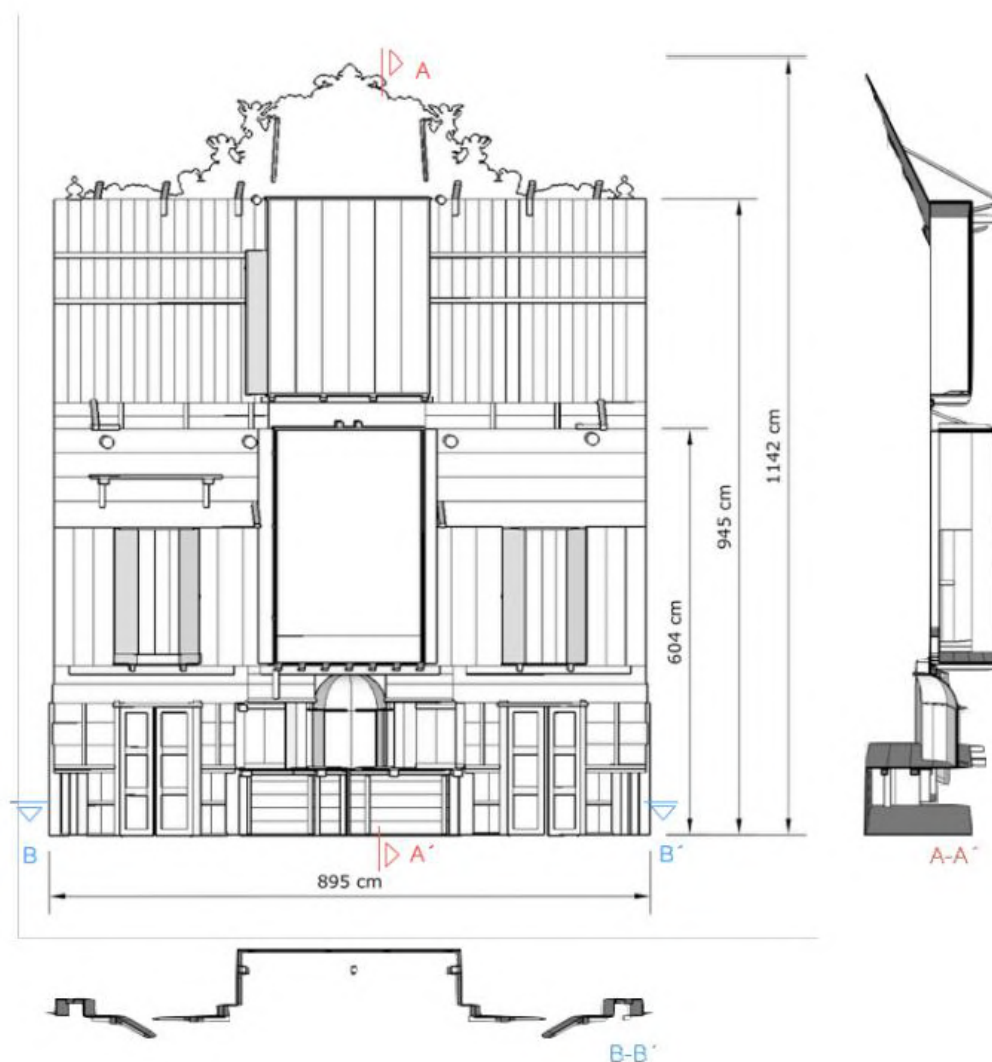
Ejemplo de sistema constructivo de caja arquitectónica. Disposición de elementos estructurales que sustenta la tablazón. Retablo Mayor de San Francisco, Icod de los Vinos. Sección vertical A-A' y sección horizontal B-B'. ©Silvia Díaz Parilla.
